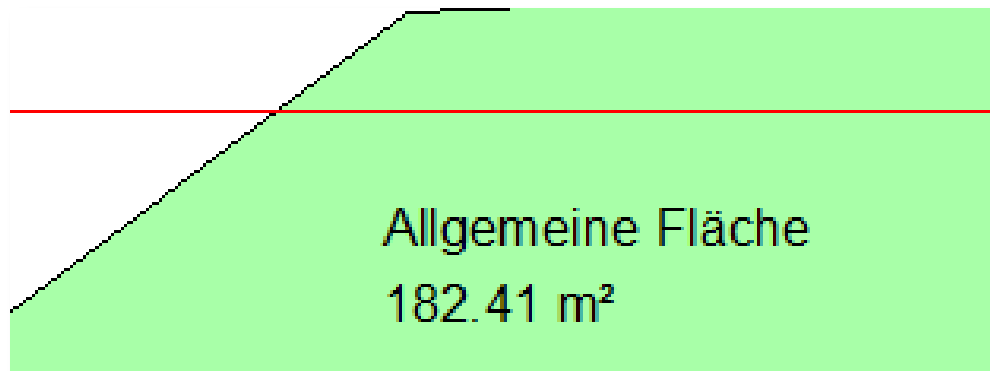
Beschriftung mit Bezeichnung und Fläche
